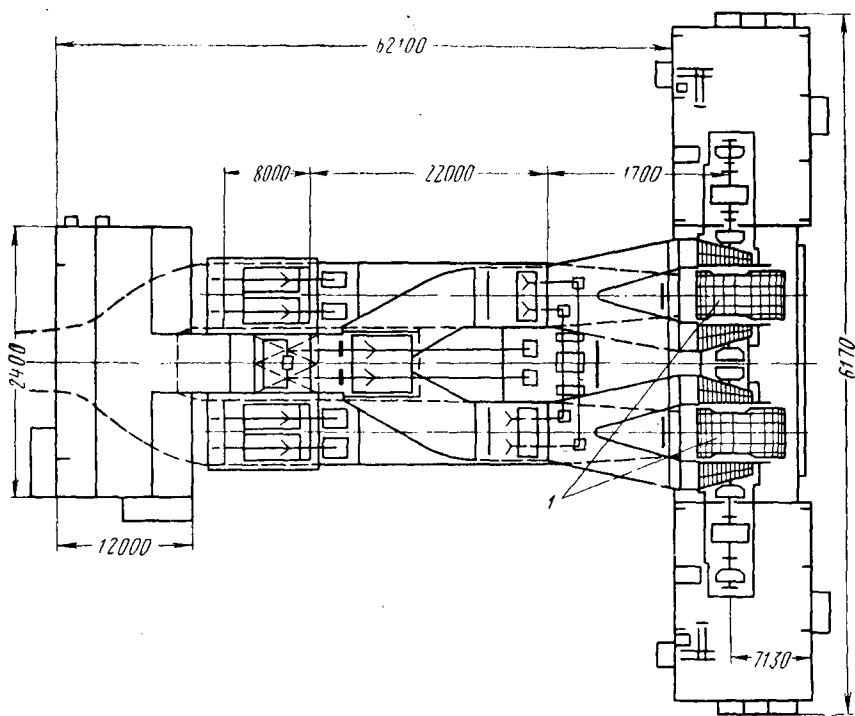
Вентиляционная установка с вентилятором ВРЦД-4,5:
